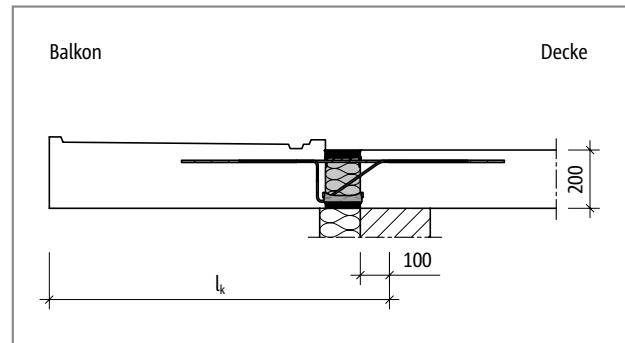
Schöck Isokorb® XT Typ K: Statisches System
